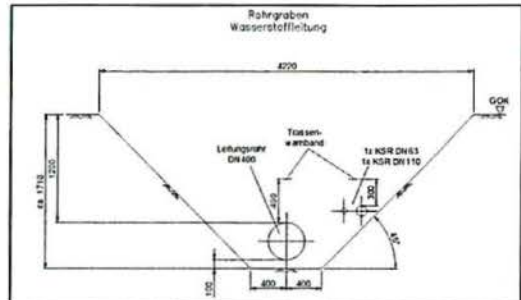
Standardgrabenprofil Wasserstoffleitung bei offener Bauweise
